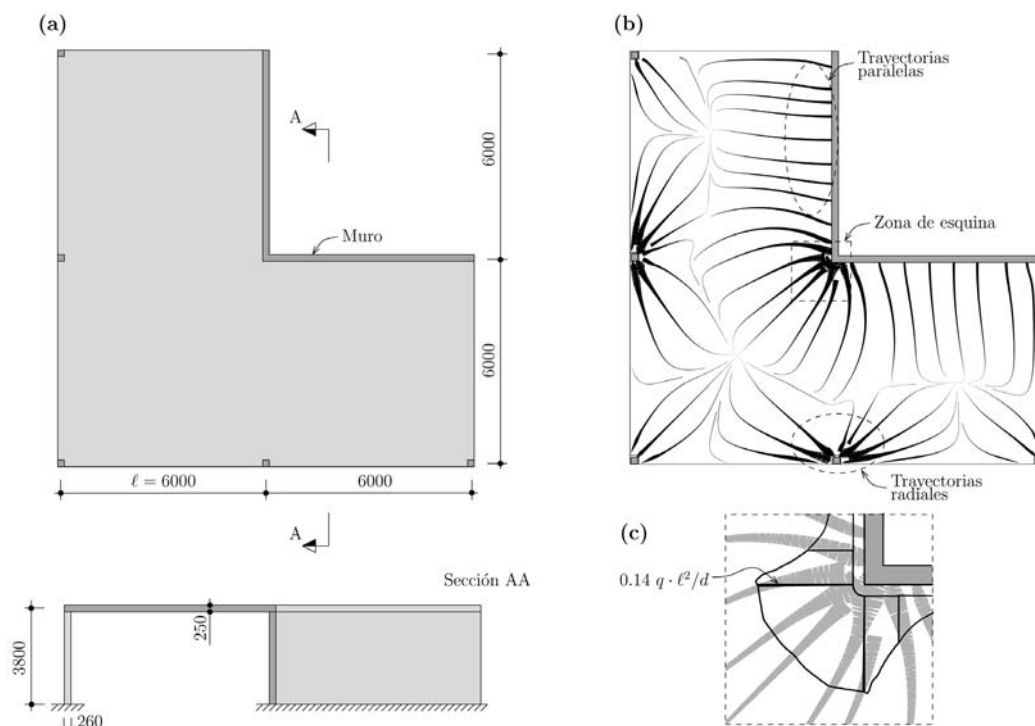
Campo de esfuerzos cortantes en una losa delgada apoyada sobre cinco pilares y un muro en forma de "L": (a) geometría de la losa (cotas en [mm]); (b) campo de esfuerzos cortantes y regiones; y (c) detalle del reparto de esfuerzos cortantes en la región de la esquina.
